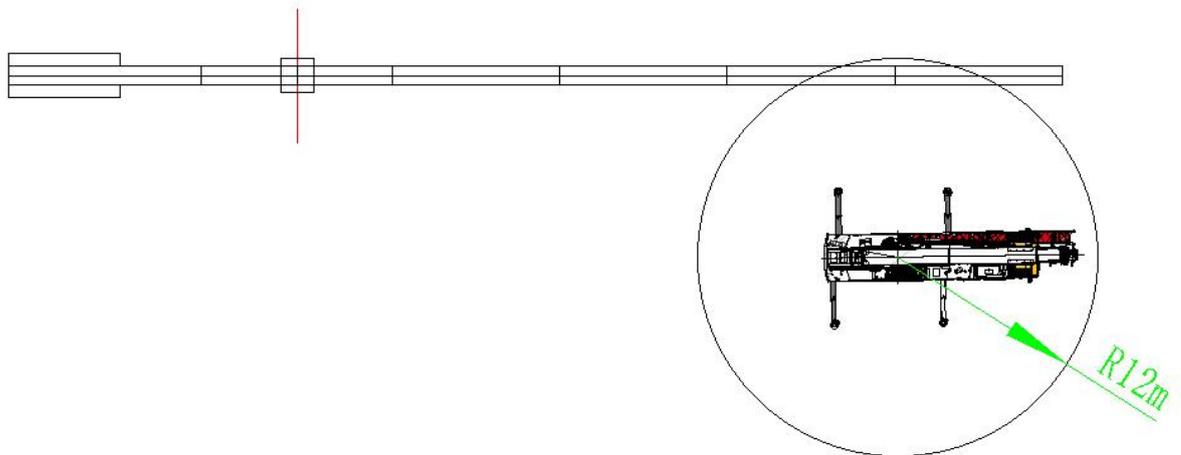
起重臂臂节三、臂节四吊装平面示意图
